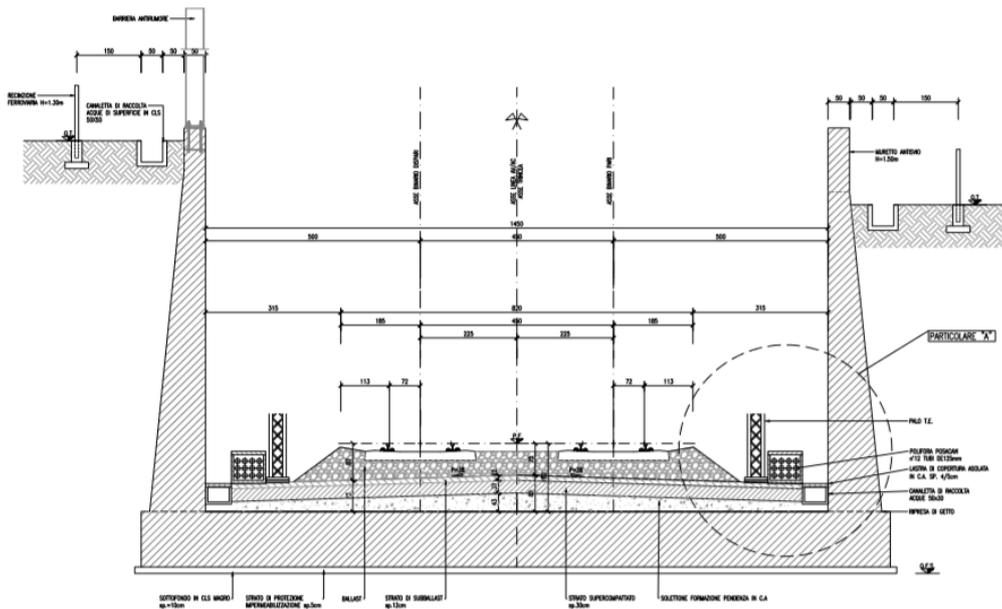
Trincea tra muri ad “U” – Sezione tipo
